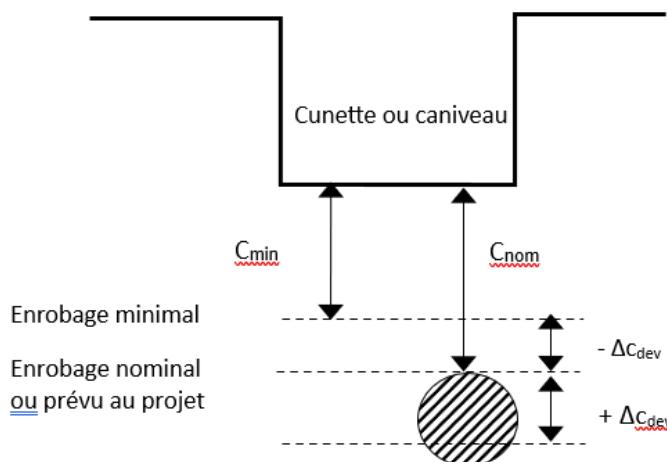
Détail du positionnement de l'armature au niveau d'une cunette ou d'un caniveau
